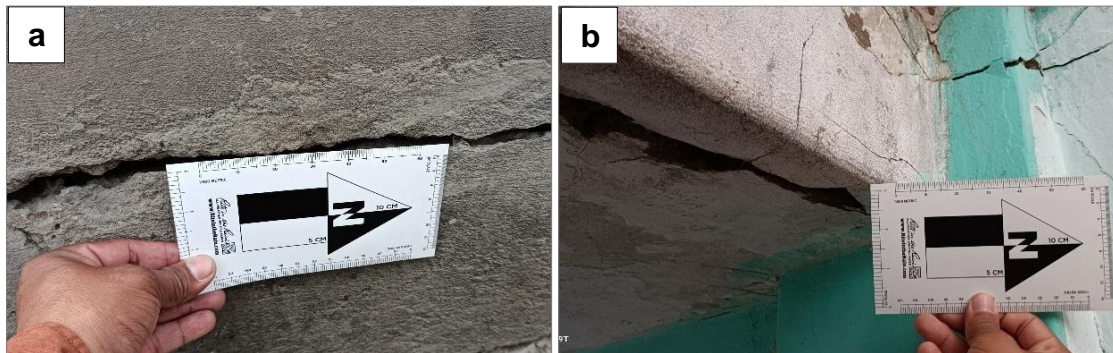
a y b) Daños estructurales en vigas y columnas con aperturas de hasta 3 cm y desplazamientos de 2 cm.
